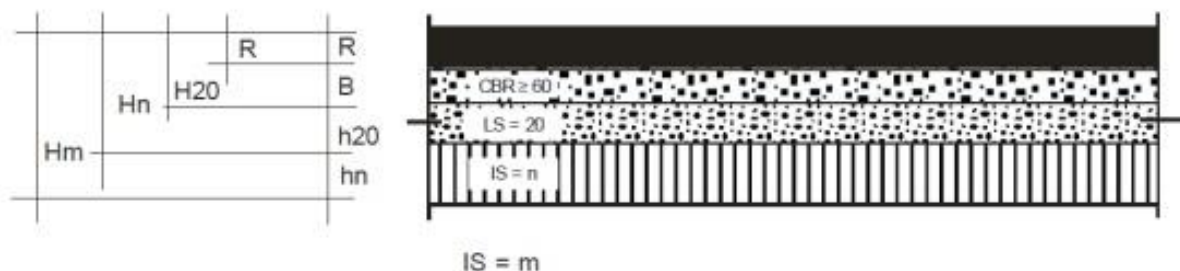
Esquema de camadas do pavimento. Fonte: DNIT (2006).
